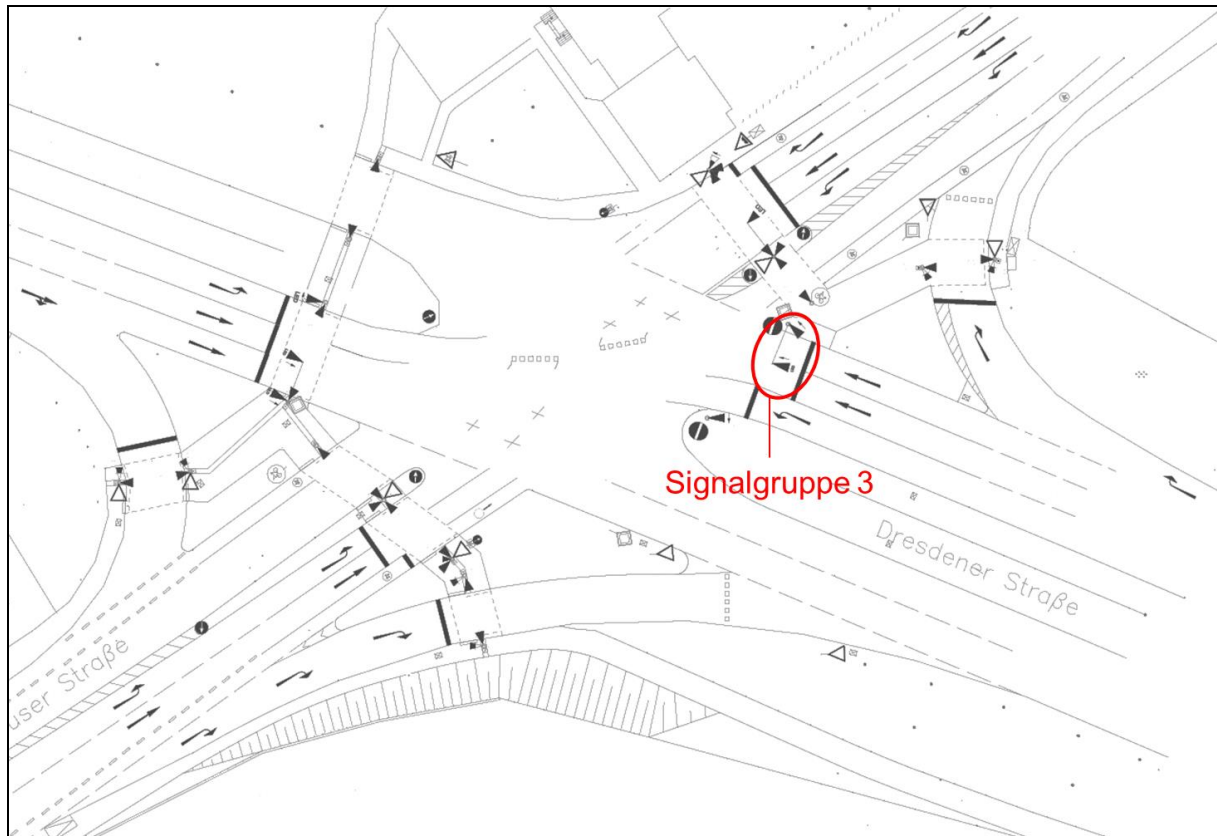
Signallageplan des KP Dresdener Straße
